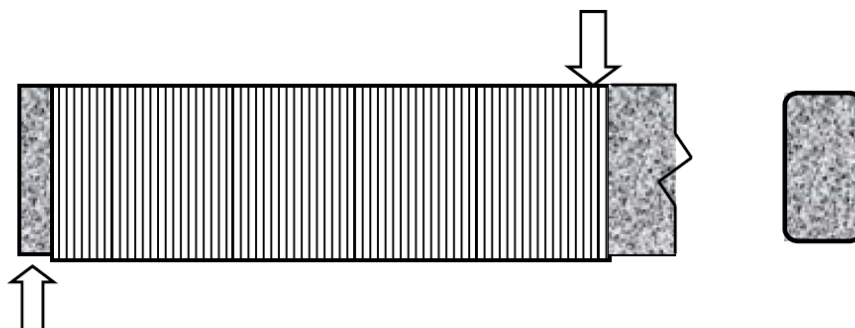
Laminado continuo en todo el perímetro de la sección
